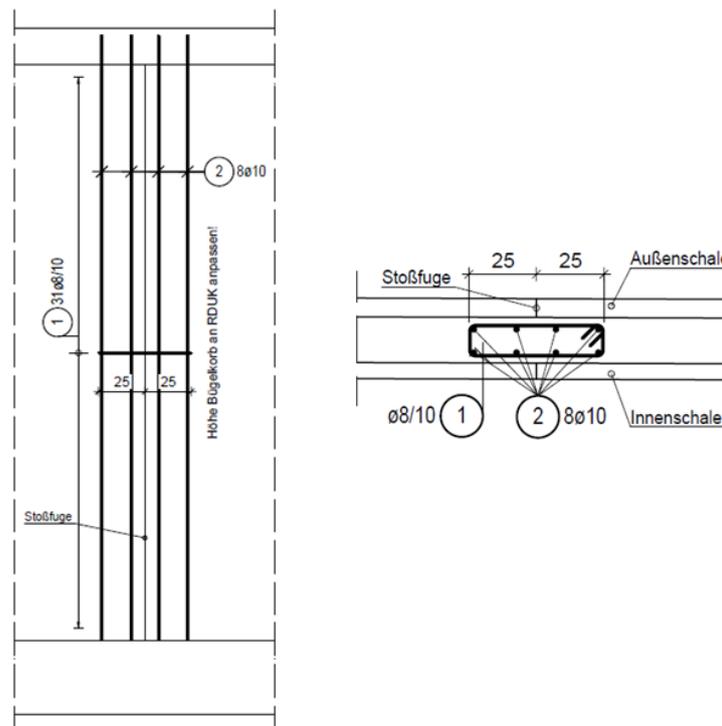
Auszüge aus einem Bewehrungsplan der Stoßfugenbewehrung [ZTK16]
